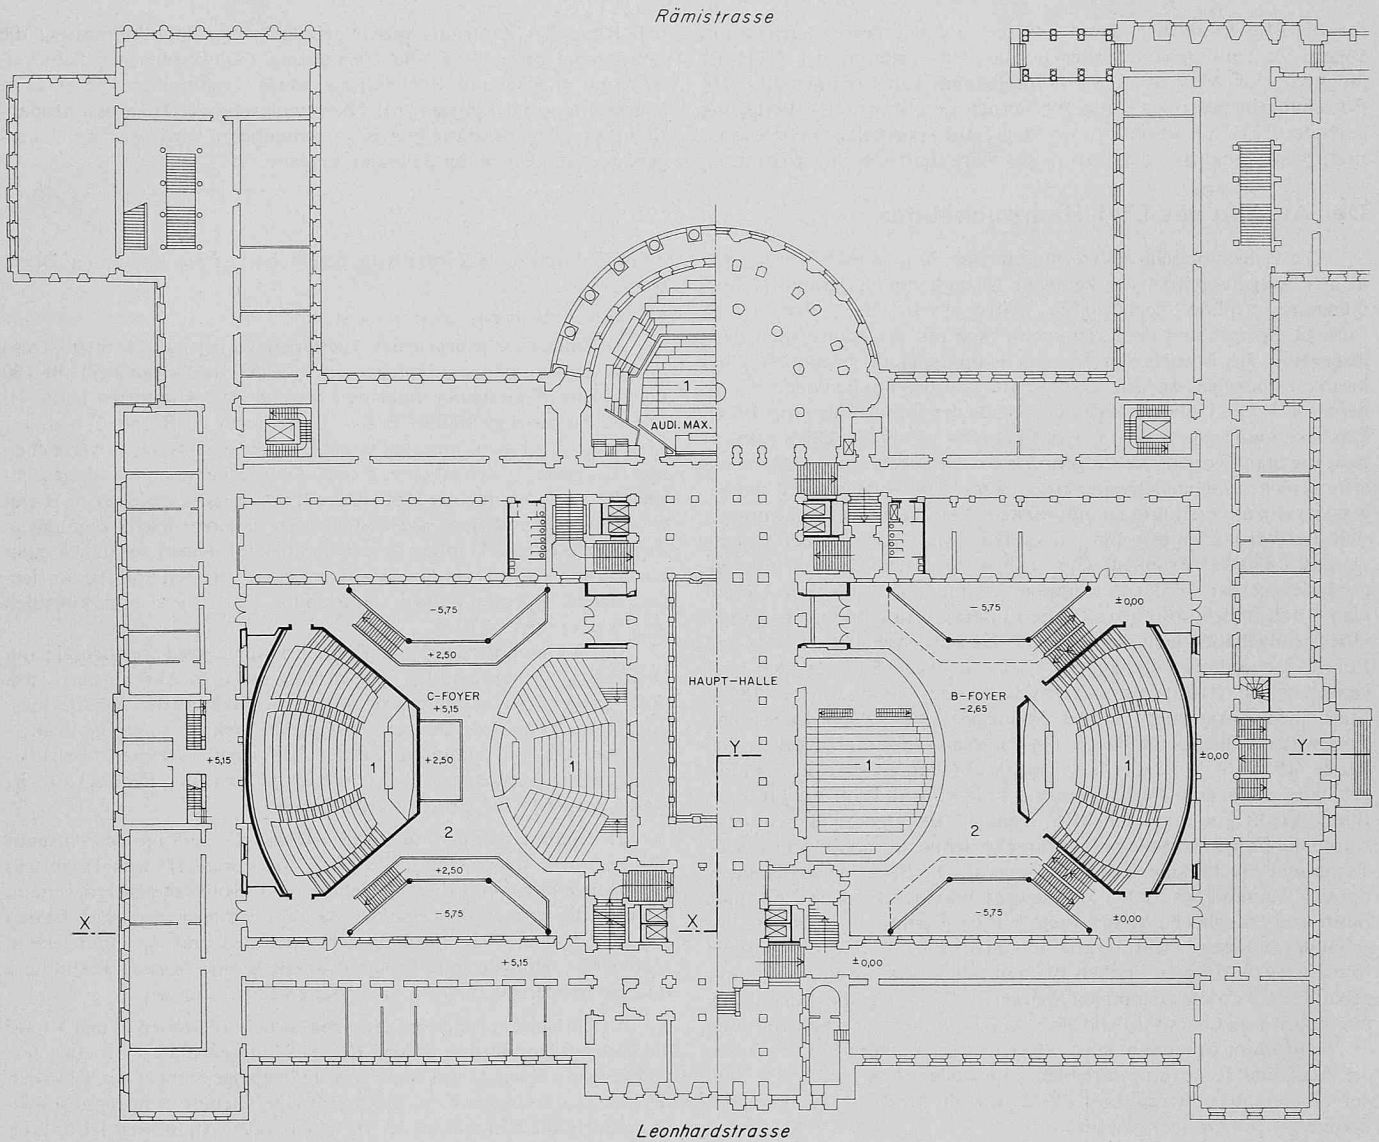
Grundriss Hauptgebäude 1:800. Kombination der Geschosse C (links) und B (rechts) mit den in die beiden offenen Höfe eingebauten Auditorien. Das durch die Glasüberdachung einfallende Licht erhellt durch die trapezförmigen Lichthöfe die Foyers und Verkehrswege. Raumbezeichnungen siehe Bild 4
